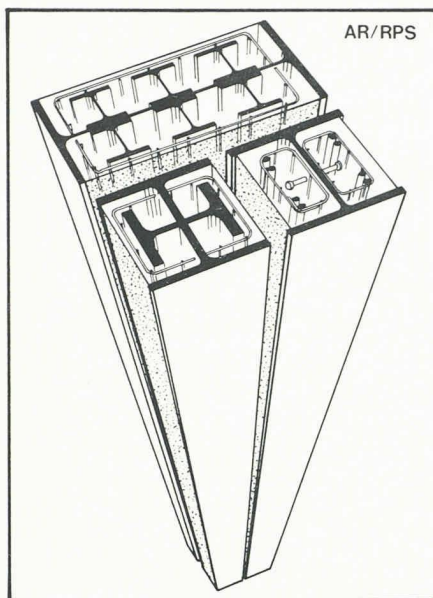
Colonnes mixtes à sections transversales rectangulaires avec semelles en acier visibles.
